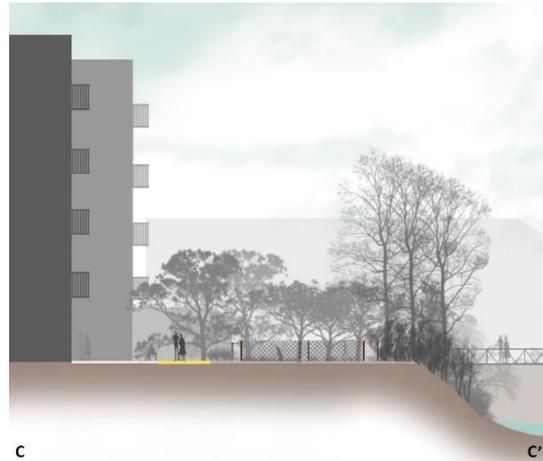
Corte esquemático transversal CC' da proposta (Ver localização do corte na Fig. 14) (Fonte: Autor)
